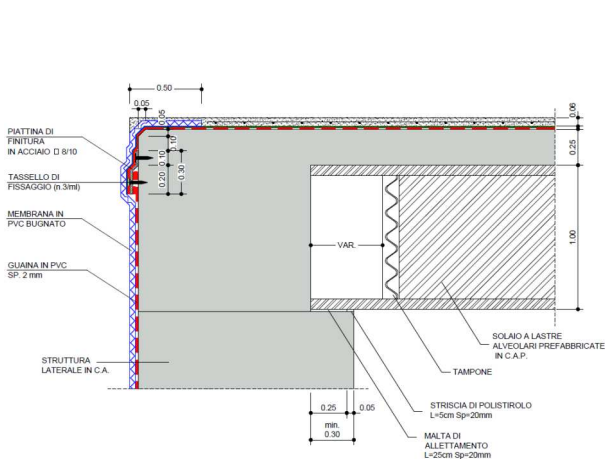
Particolare impermeabilizzazione risolto su travi prefabbricate (Sezione scatolare)
